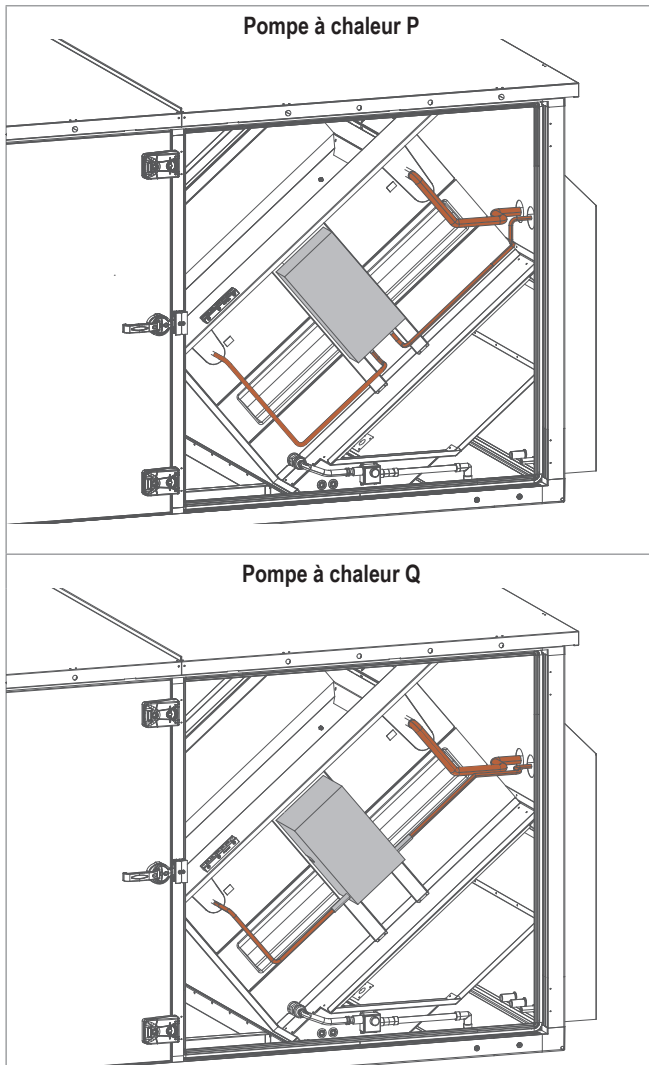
Installation des conduites frigorifiques dans l'appareil de toiture
